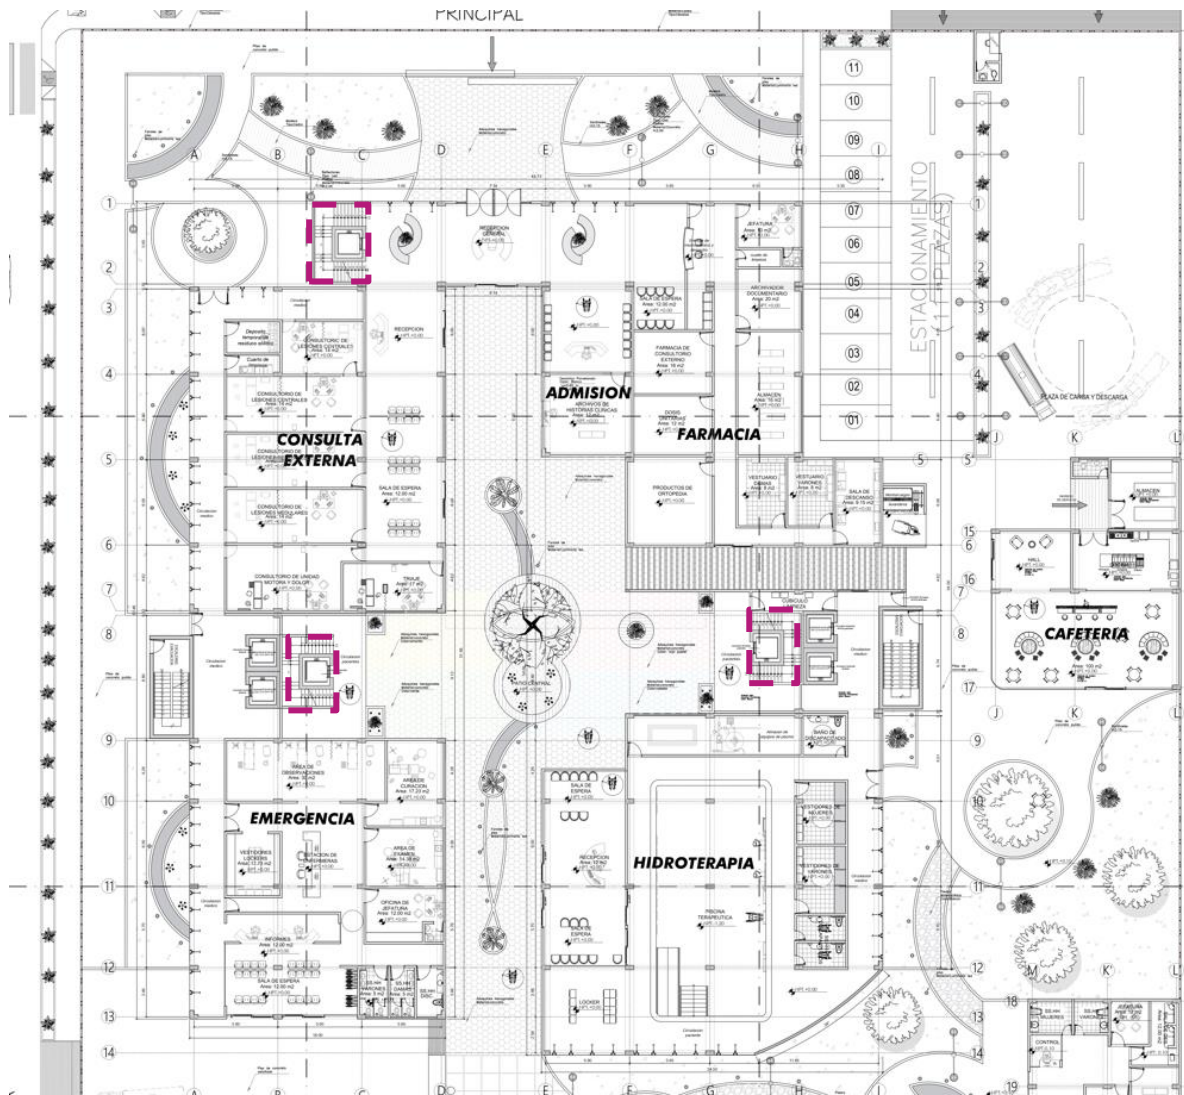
Escalera integradas - Planta arquitectónica primer nivel
